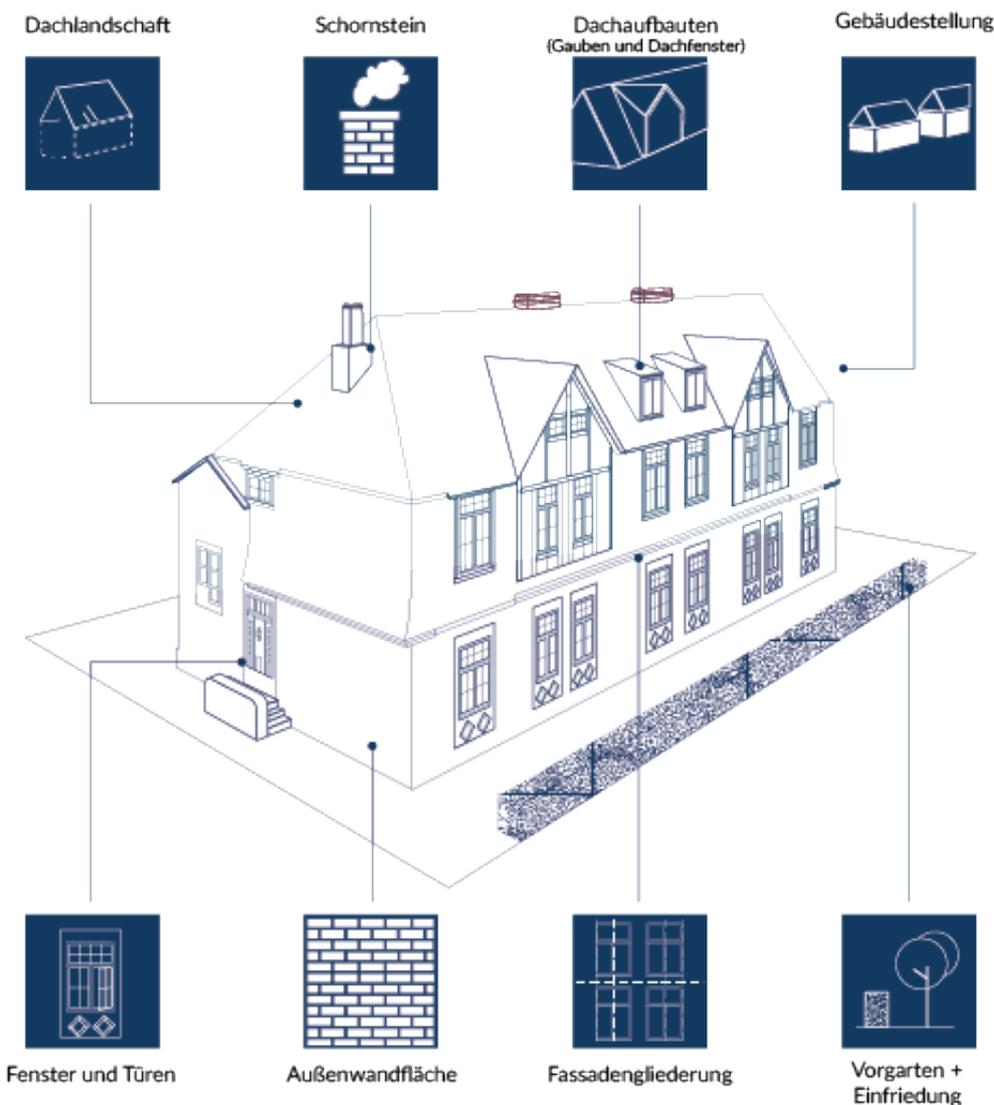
Prägende Elemente der Gebäude des Beamtenviertels
